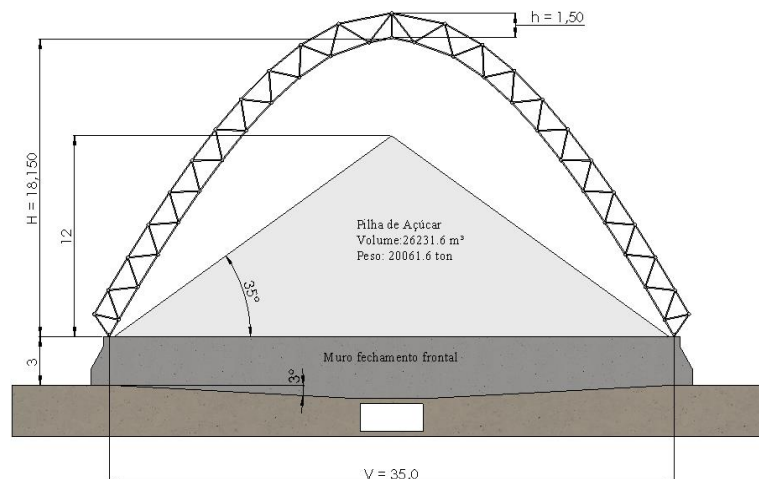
Vista Frontal da Configuração Inicial da Estrutura.
